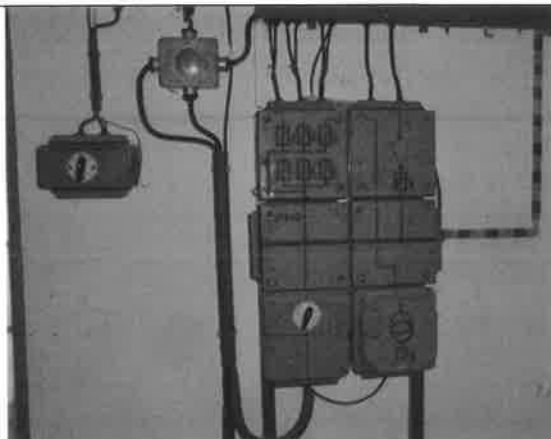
(Poziom +1.10) – klatka schodowa –
